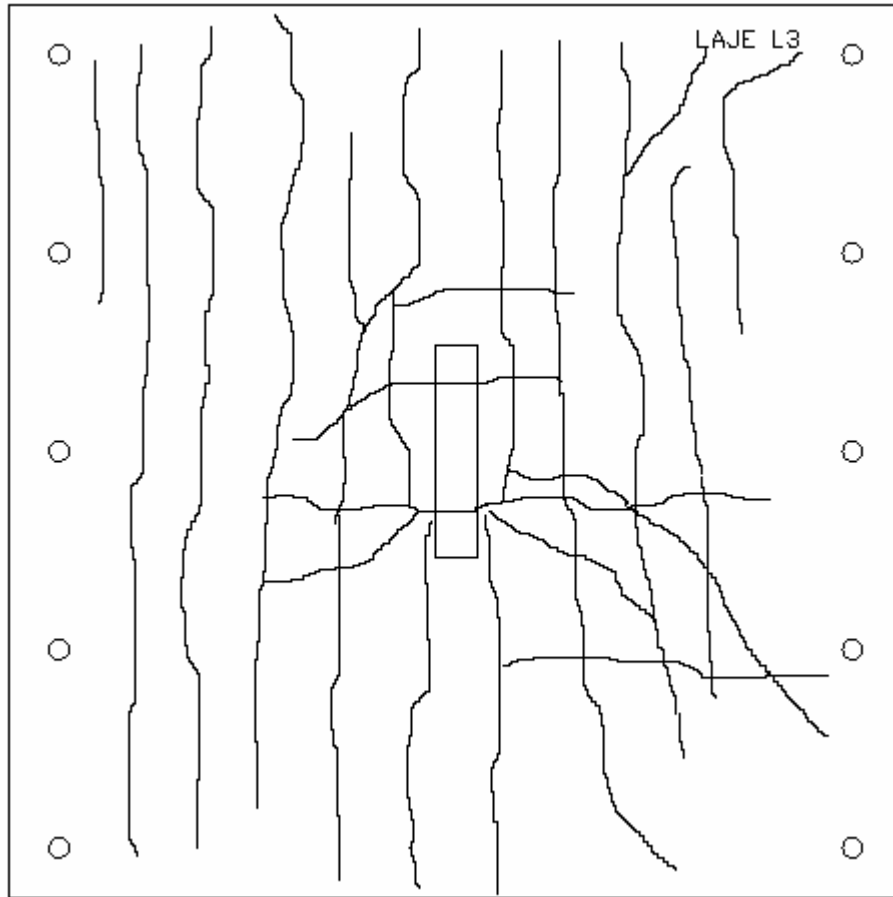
Mapa de fissuração da laje L3
